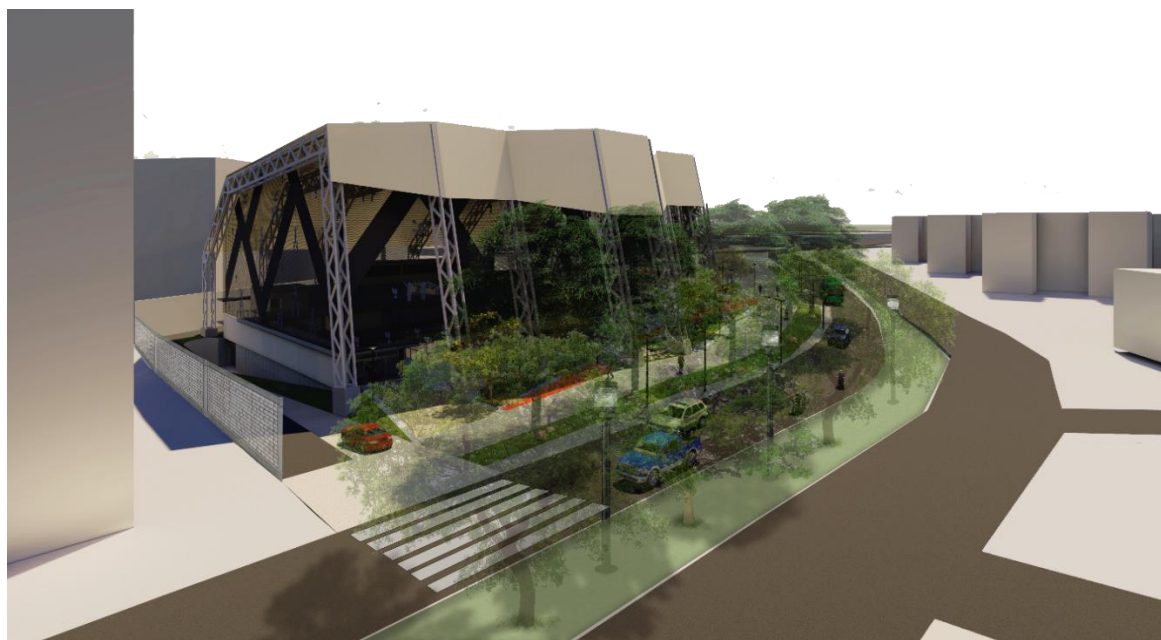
Renderizado vista desde la calle 56 (sur-norte), Centro comercial Acrópolis. Elaboración propia.
